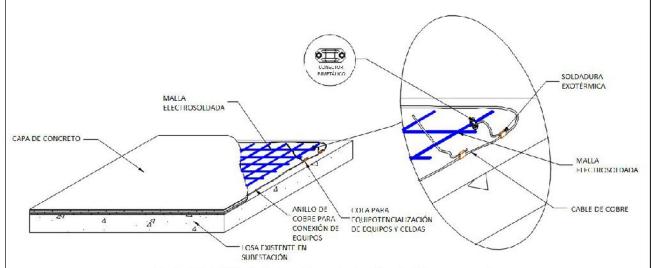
Detalle de la malla equipotencial embebida en concreto.
